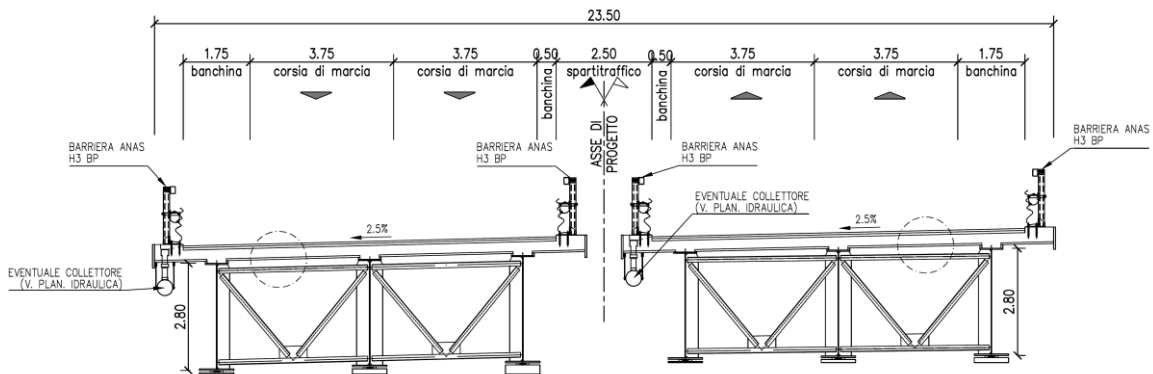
Sezione tipo Asse Principale su Scavalco canale IMBOI
